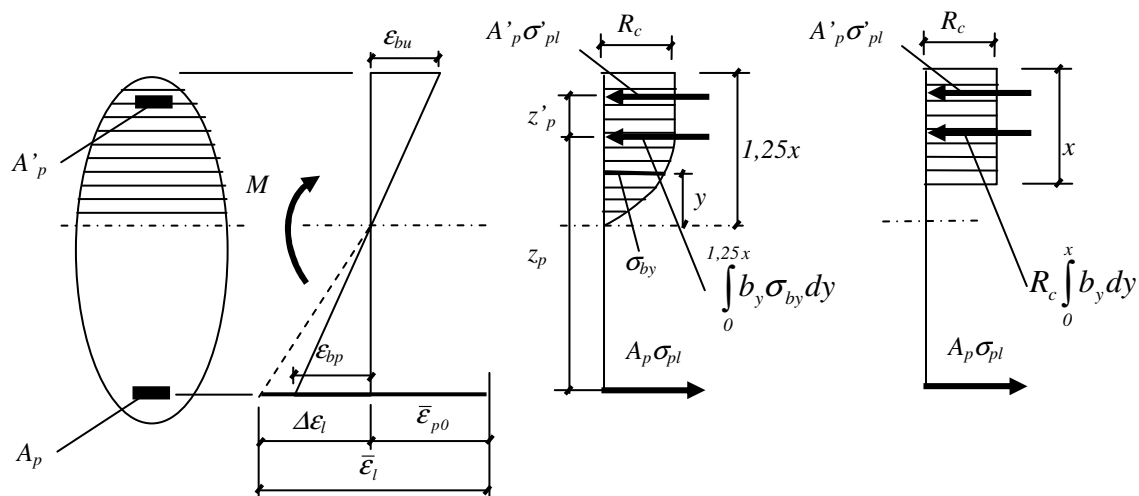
Starea de eforturi și de deformații la SLU a secțiunii de beton precomprimat solicitată la încovoiere
